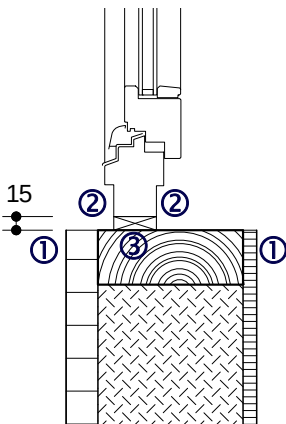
Bei der Herstellung des Rohbaus werden die Außen- und Innenbekleidungen bündig ausgeführt ①. Das Fenster ist innen und außen mit einem Falz ② ausgestattet. Beim Einbau werden unterhalb der vertikalen Rahmenhölzer Auflagerklötze ③ positioniert, um die Eigenlasten des Fensters in die Rohbauwand sicher abzuleiten.
